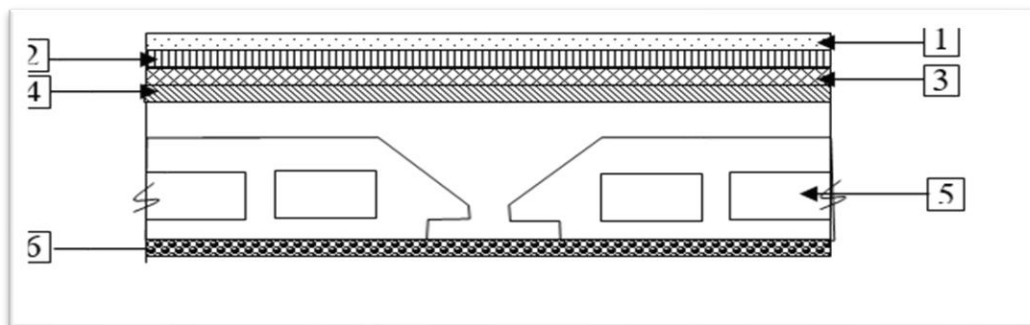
Coupe transversale d'un plancher à corps creux (Plancher terrasse)
